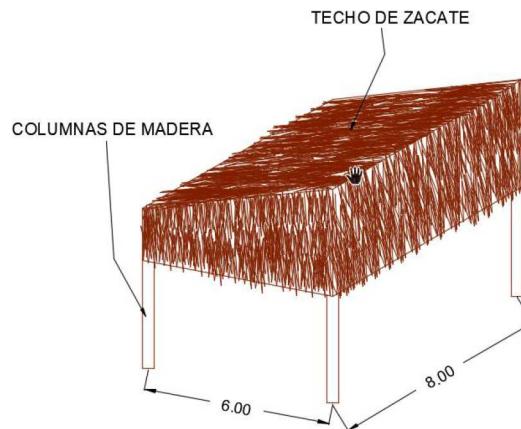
Tipo de Palapa que se pretende Instalar.
